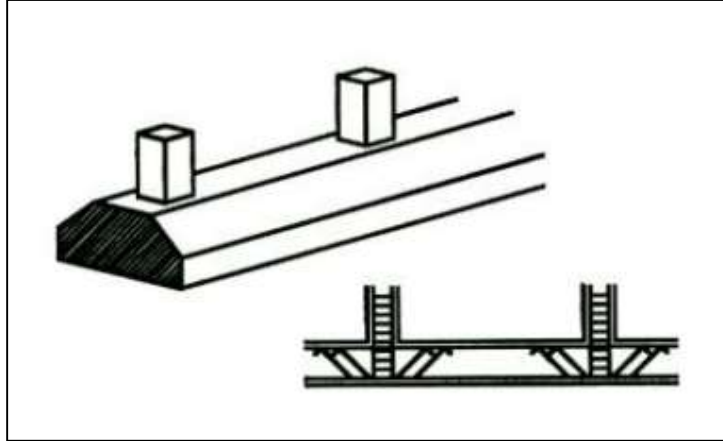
ábra. Vasalt pilléralap, betonozás előtti állapot, [15]
